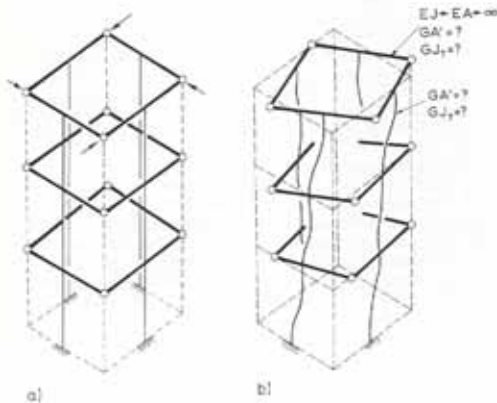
Geschlossener Kern mit quadratischem Querschnitt
